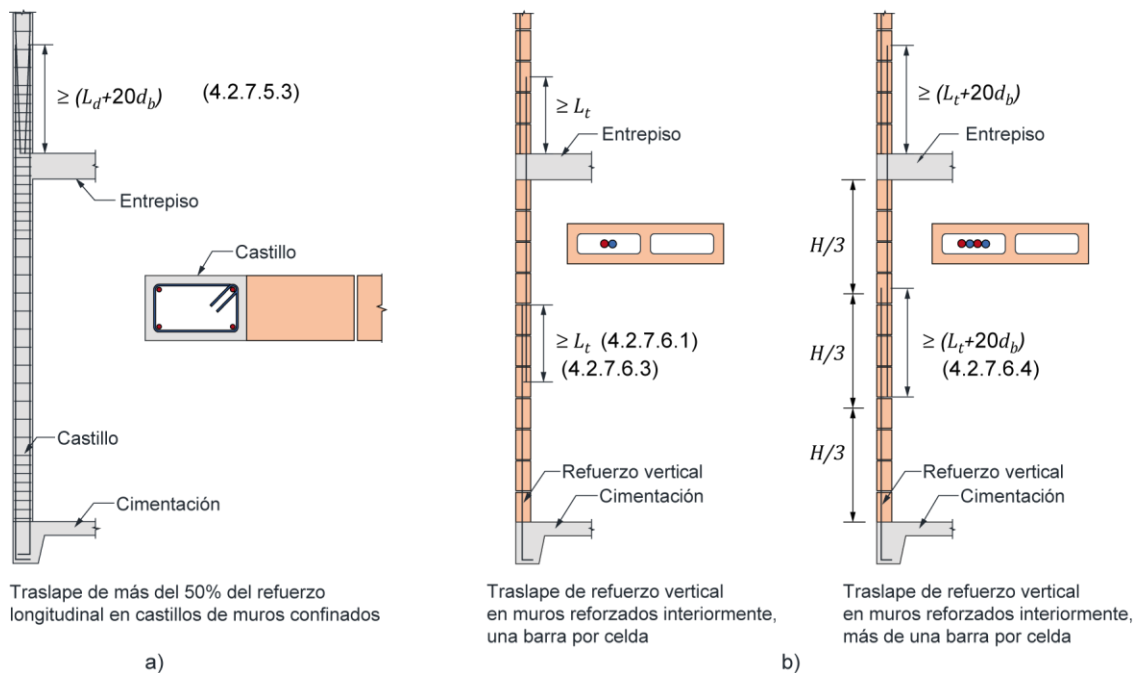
Longitudes de traslape de barras: a) en castillos de muros confinados y b) en muros reforzados interiormente
